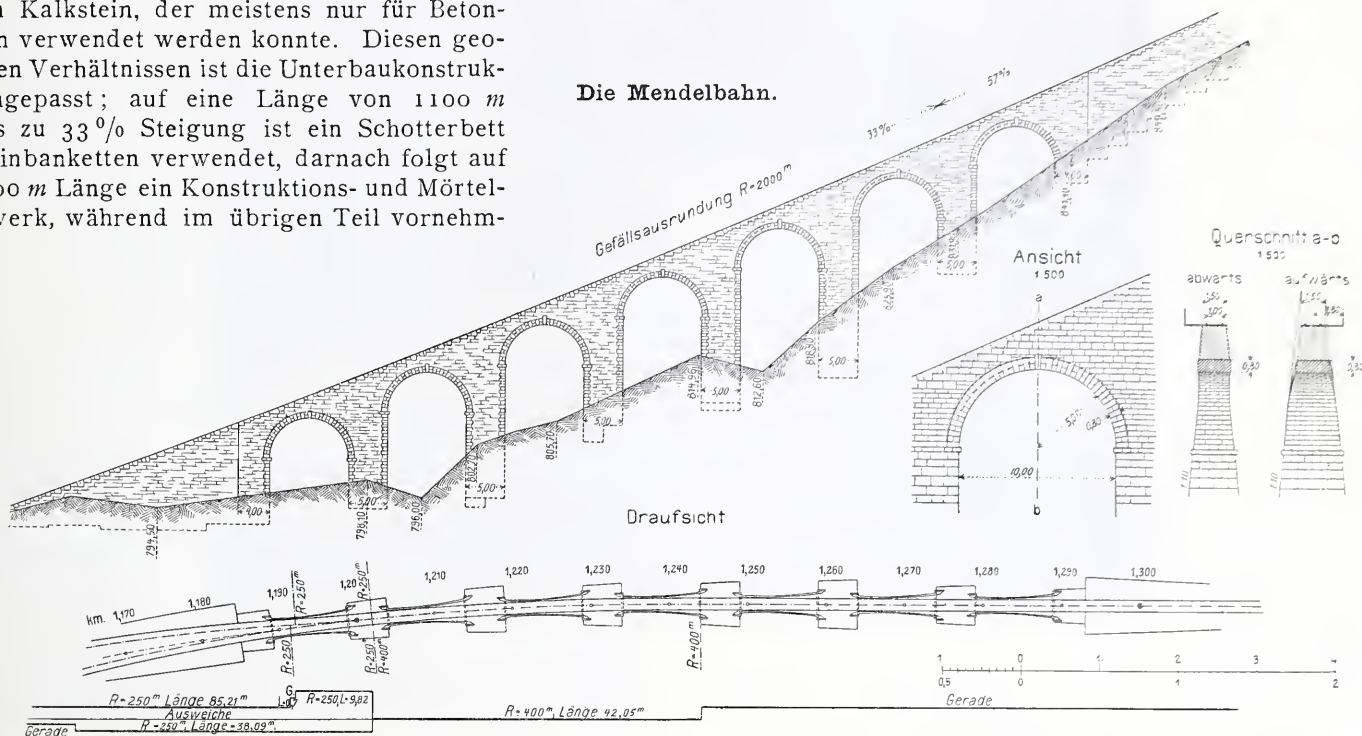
Viadukt von 100 m Länge. — Grundriss und Ansicht 1 : 1000. — Details 1 : 500.
